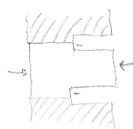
Boceto en planta de la geometría y de la construcción situada en la Rúa Celso Rivas Perez, nº 9 (autoría propia).
